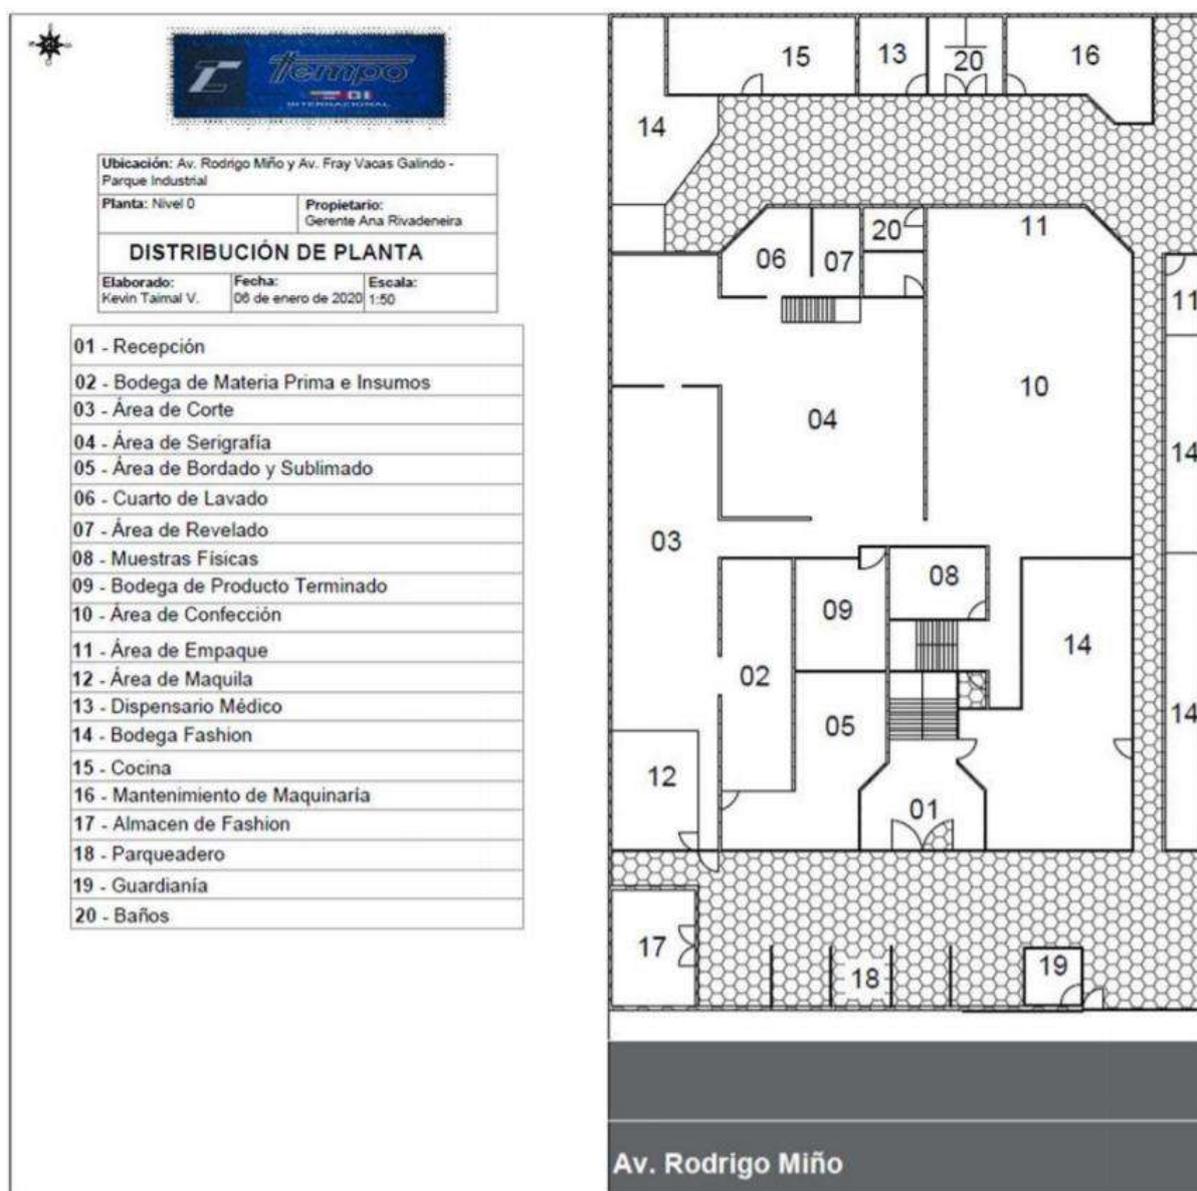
Layout planta baja de Tempocodeca Cía. Ltda.
